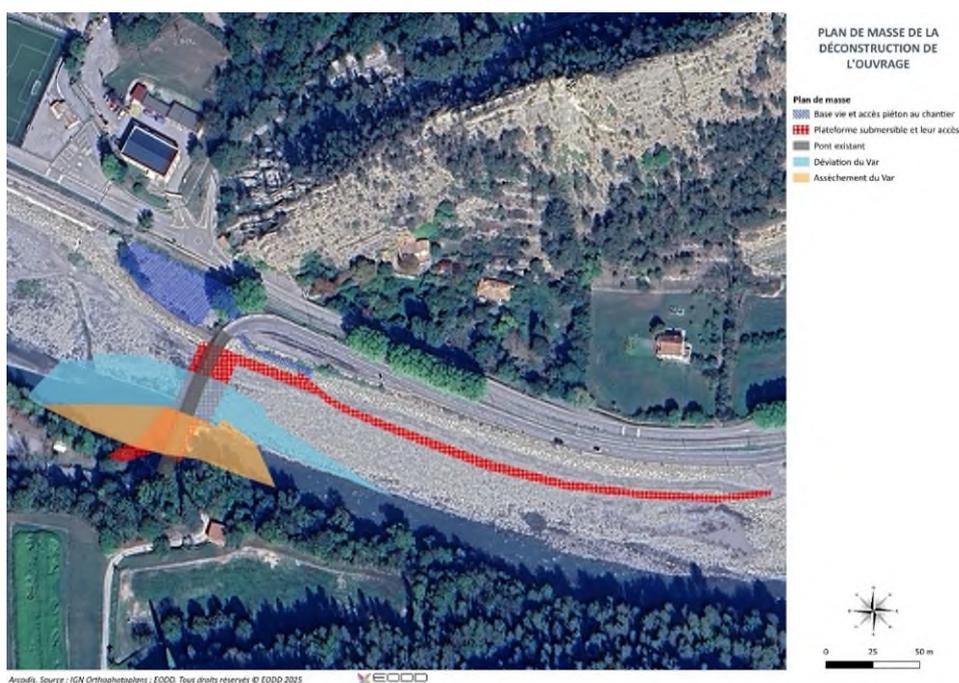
plan de masse de la déconstruction de l’ouvrage existant
